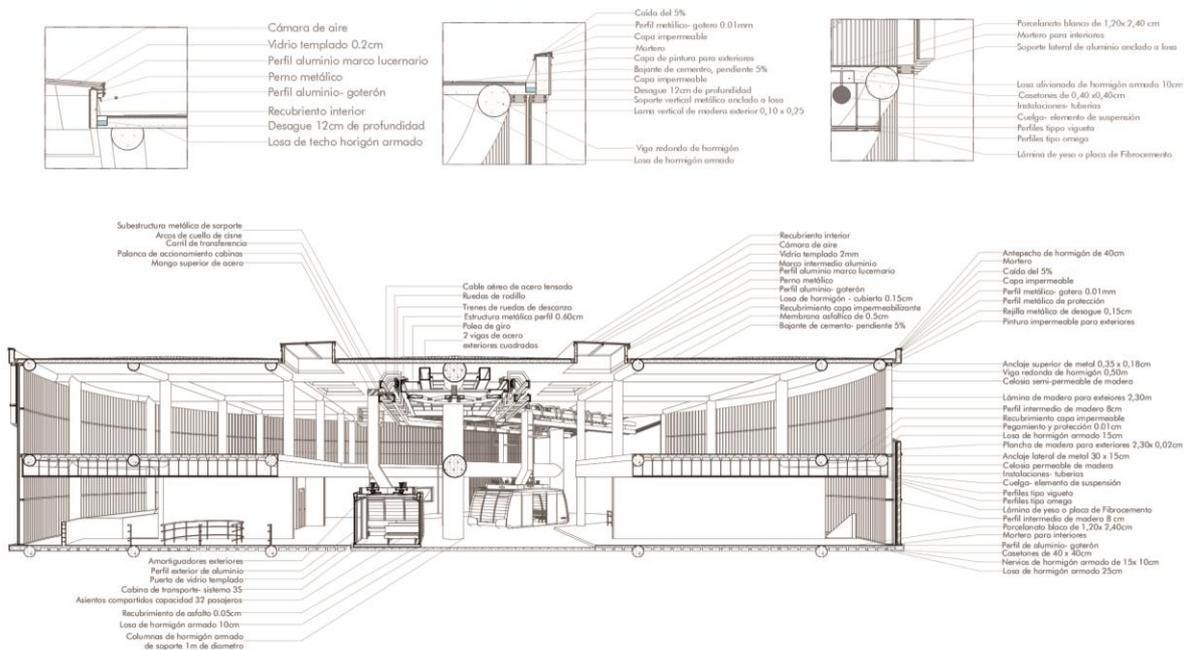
Detalle constructivo sistema teleférico. Elaboración propia.
